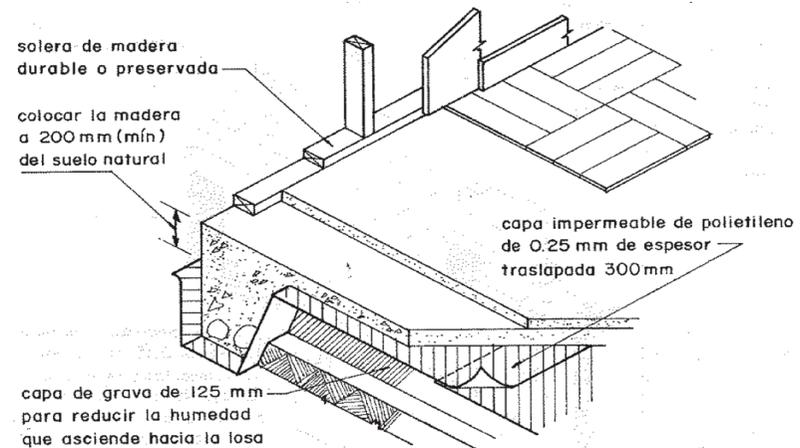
Protección de la humedad del suelo en una placa o losa de cimentación
